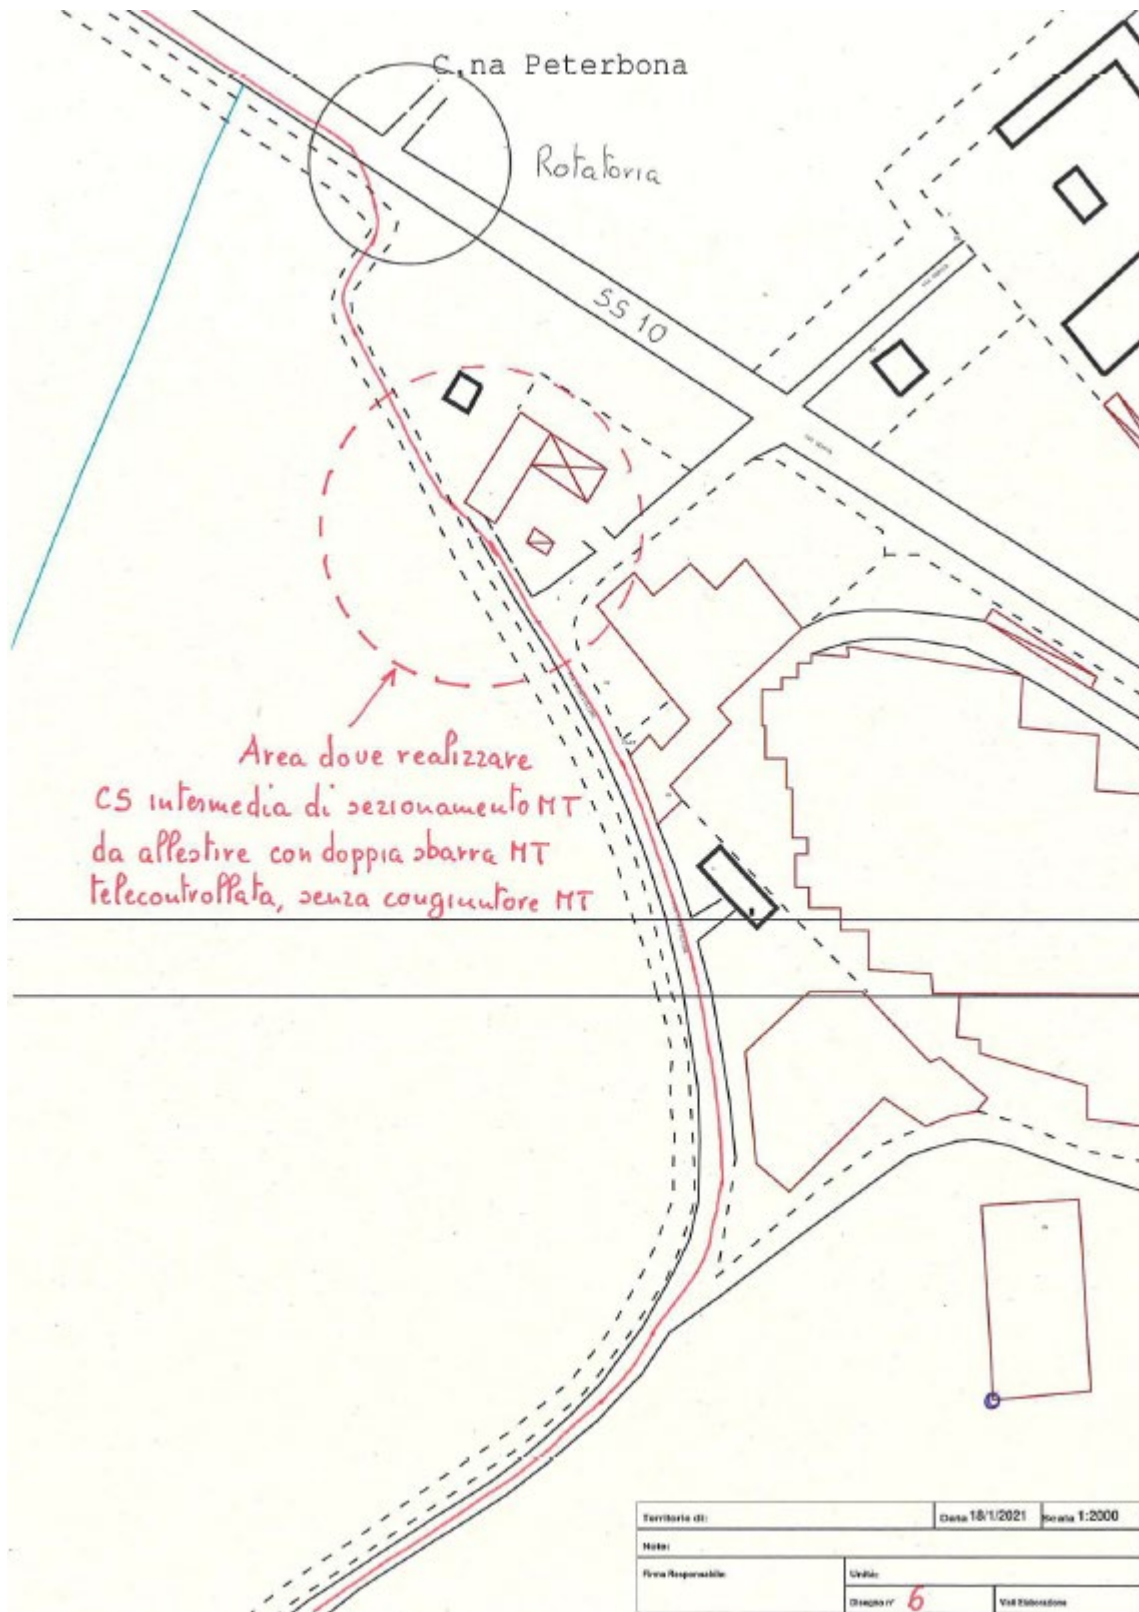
Ubicazione indicativa cabina di sezionamento e tracciato cavidotti di connessione lungo Via della Stortigliona secondo planimetrie STMG
